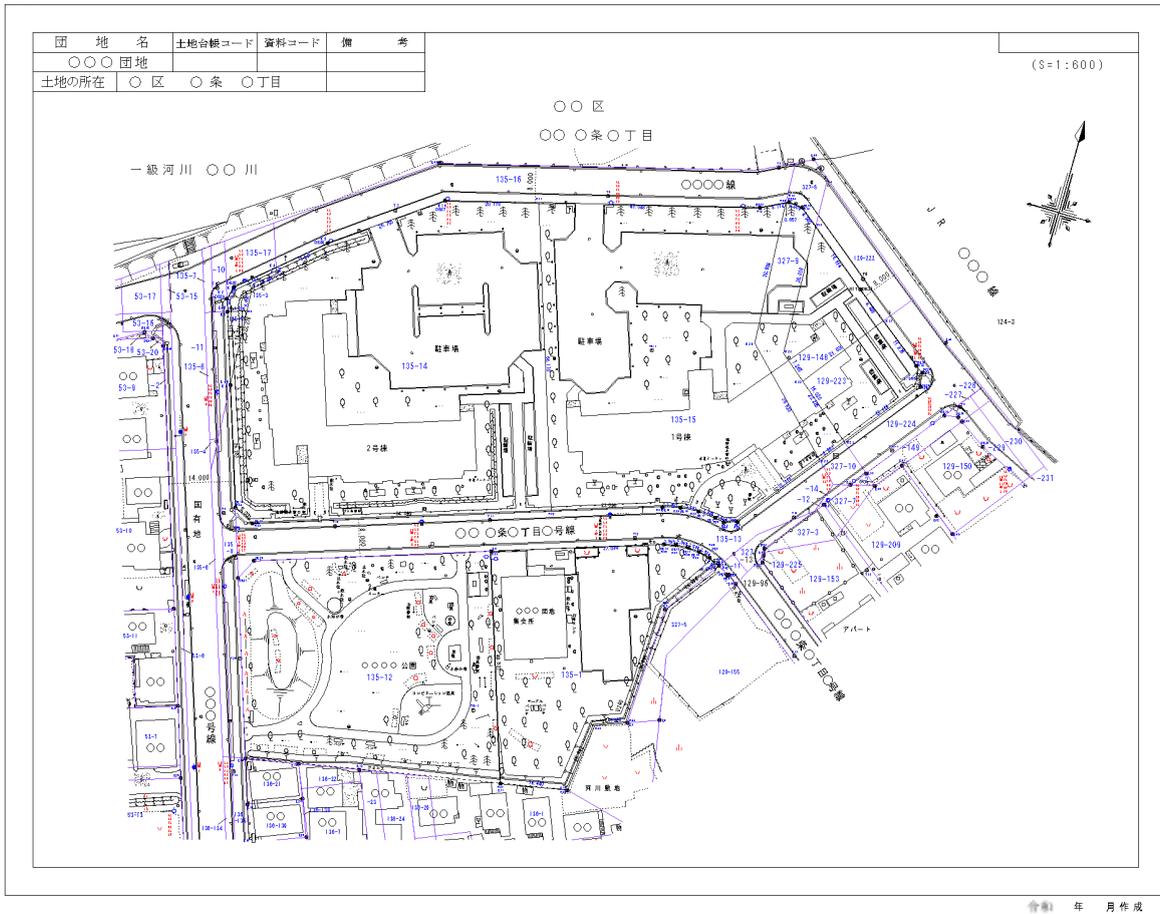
住宅課 管理図 標準レイアウト (現況平面図)
